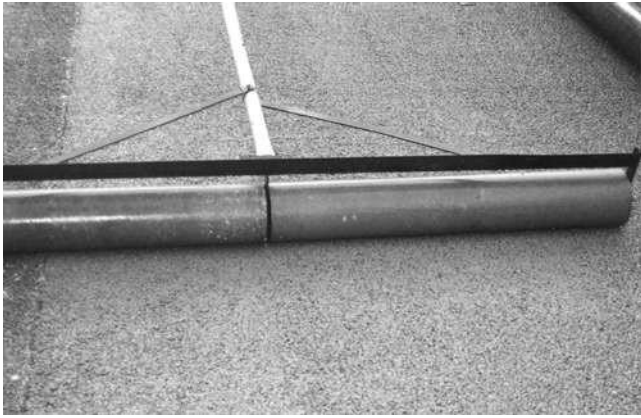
secundaria utilizada para el concreto permeable transversal de laminación para mejorar la calidad de conducción de pavimento.
